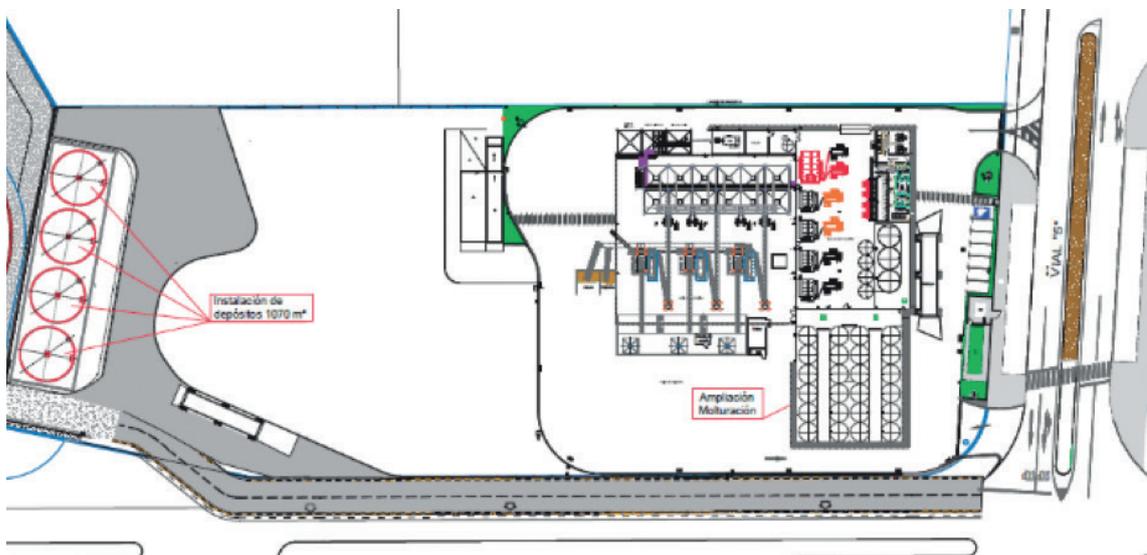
Plano en planta. Modificaciones proyectadas en la zona de molturación.
